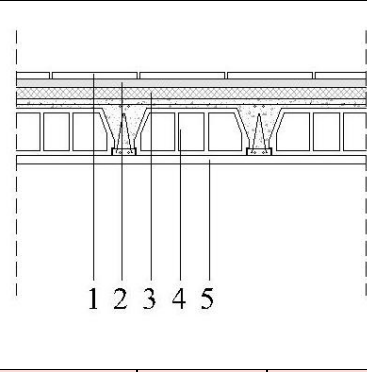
Planimetría EA de tipología de divisiones horizontales. Fuente: Elaboración propia.
